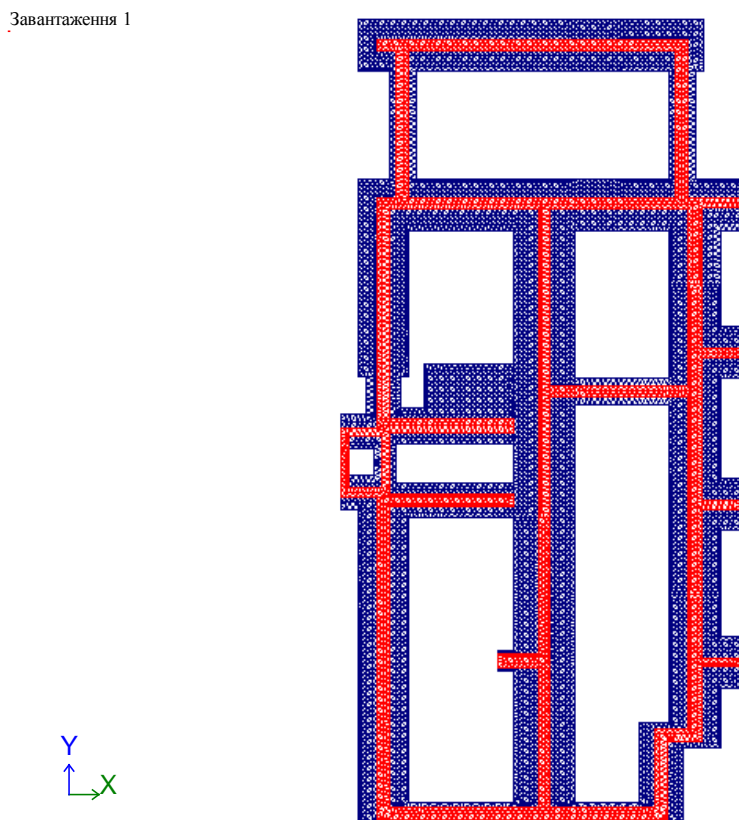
Моделювання площадки від фундаментного блоку (виділено червоним)
